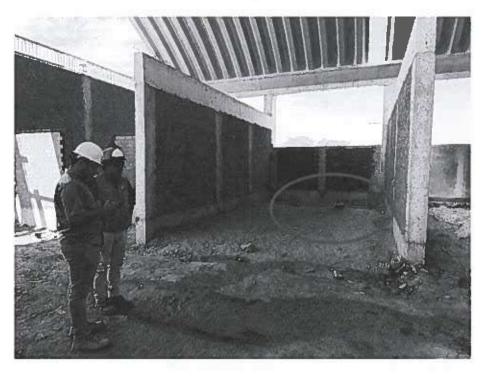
Se verifica el encofrado de vigas dentro del bloque N.º 15.
